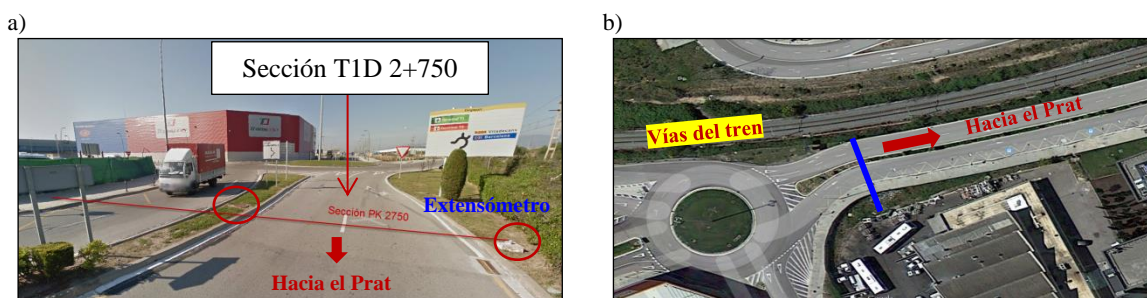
2. a) Vista desde satélite en alzado b) Vista desde satélite en planta sección T1D PK 2+750 Fuente: Google Maps
